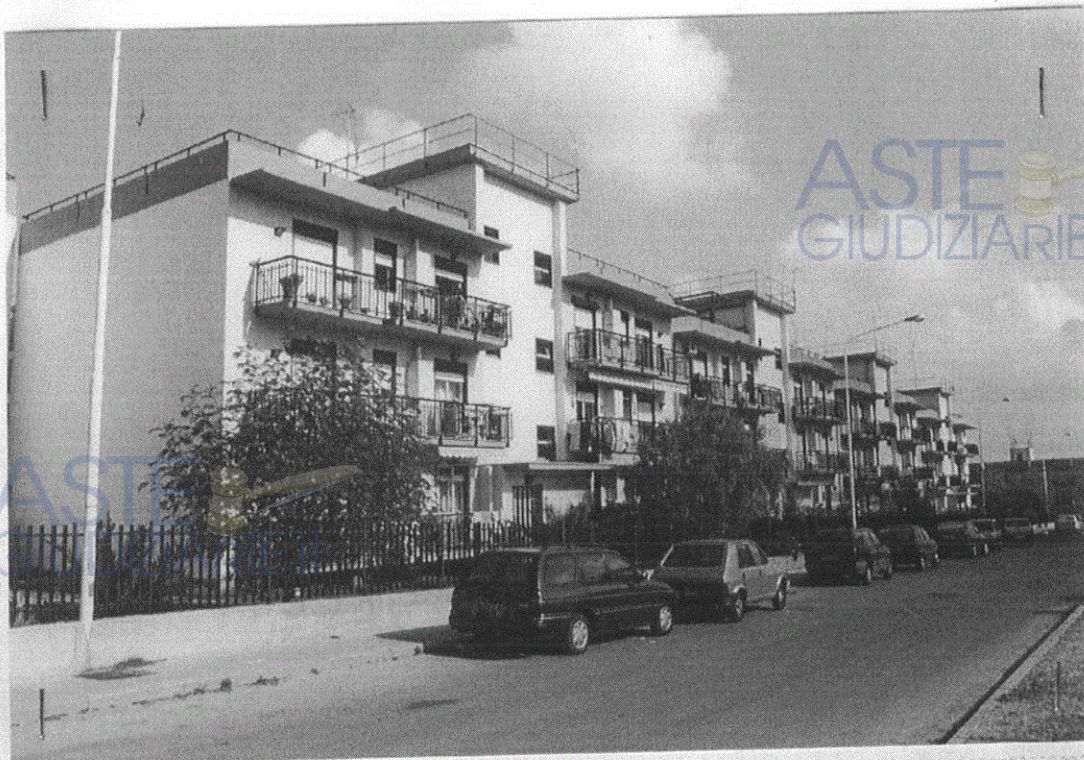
EDIFICIO S7 - PROSPETTO SUD
